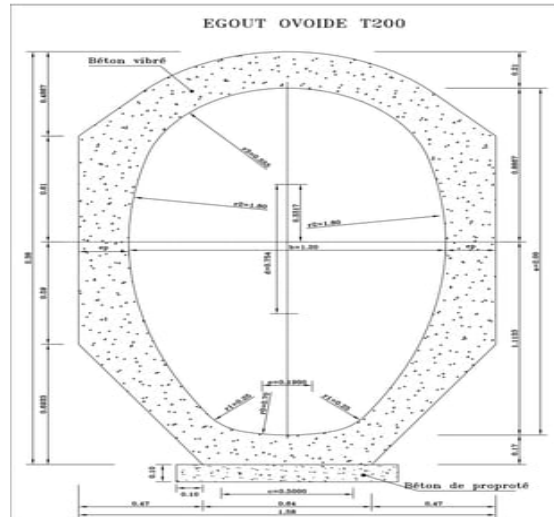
Coupe type d'un tuyau ovoïde préfabriqué
